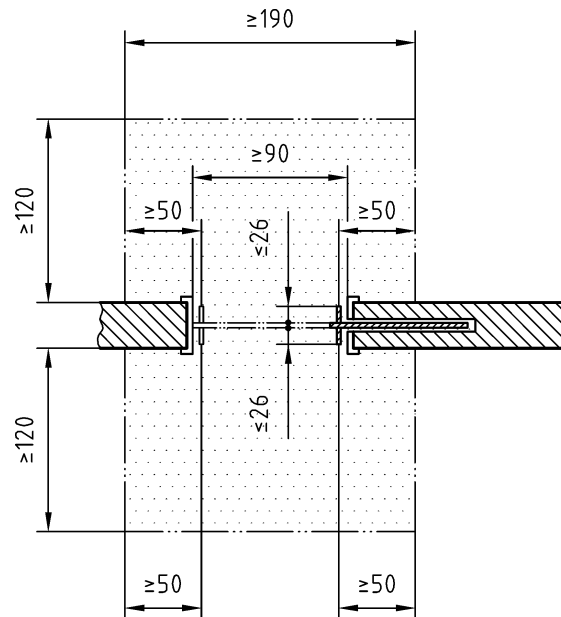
Maße für und Bewegungsflächen vor Schiebetüren
